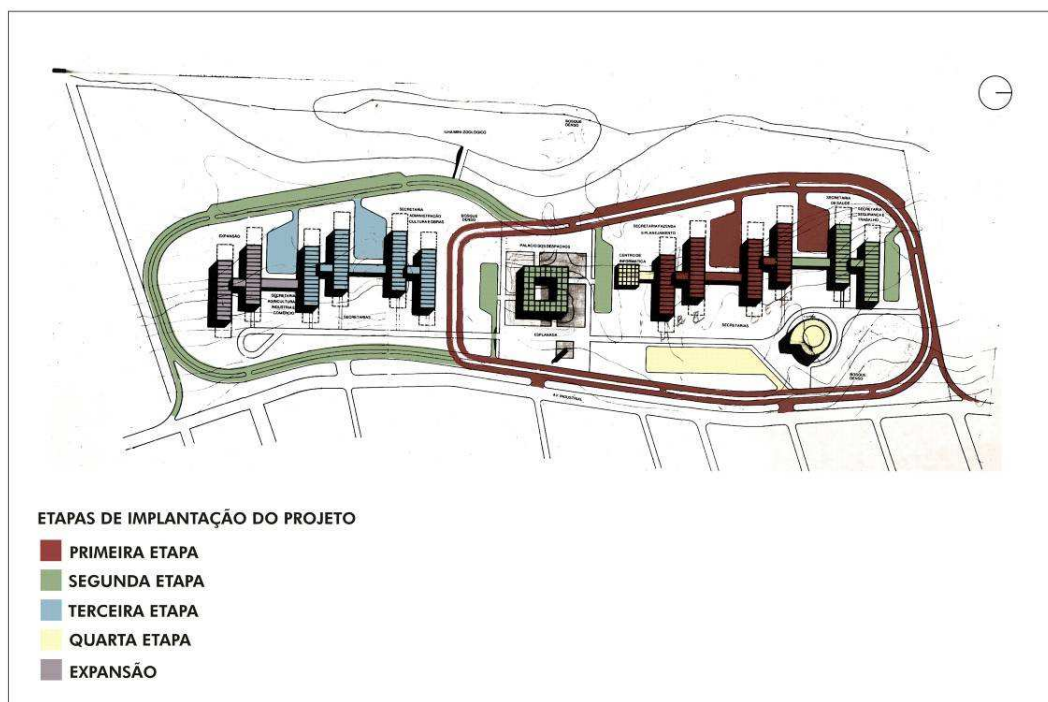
Planta de situação do projeto original | Etapas de implantação | Editada pelo autor.
